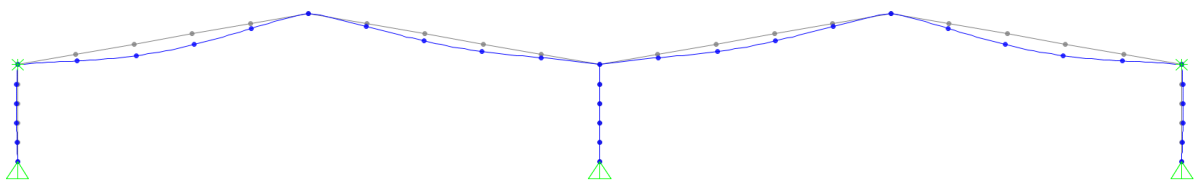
Configuração deformada com os deslocamentos horizontais impedidos (Pórtico PR2)
